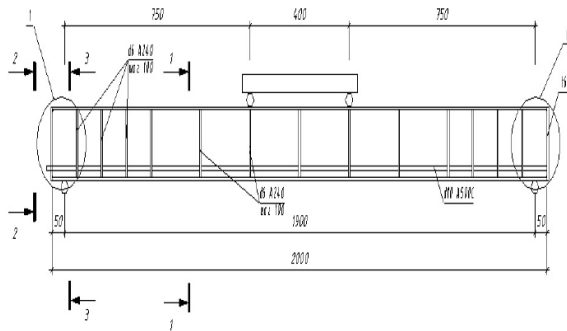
Сталежелезобетонная балка с прямолинейной преднапряженной арматурой
